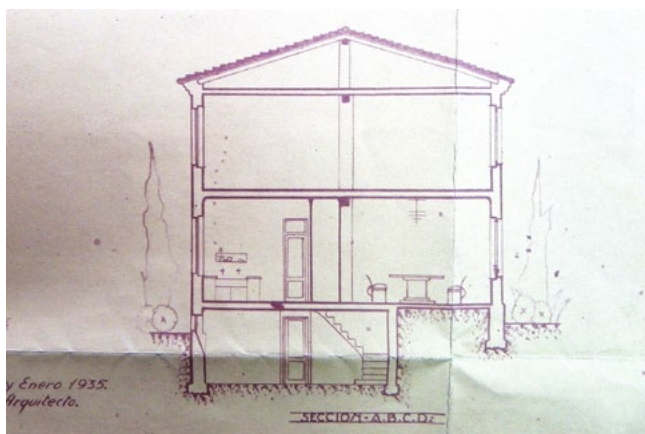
Sección de proyecto de casa barata en el ensanche para León Navarro Larriva (1935). Proyecto. Fuente: AMT, Cod. 3-1-2-5. Sig. 2665-31.
